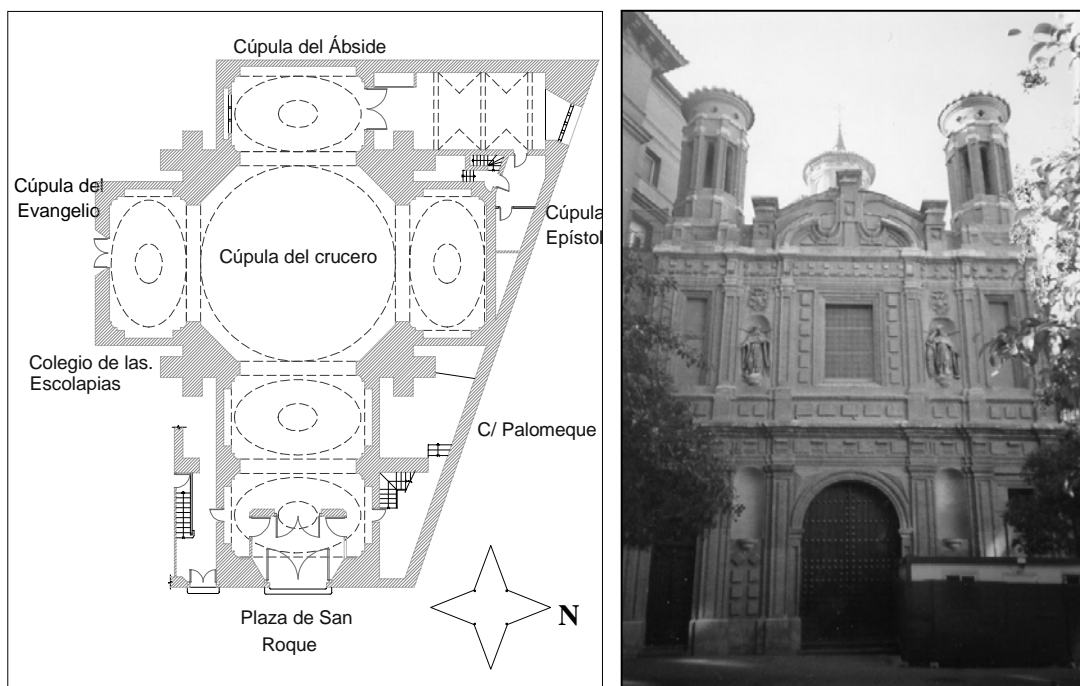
Planta del edificio con la cúpula del Evangelio del lado sur y vista de la portada desde la Plaza de San Roque, a la izquierda el edificio del colegio.
